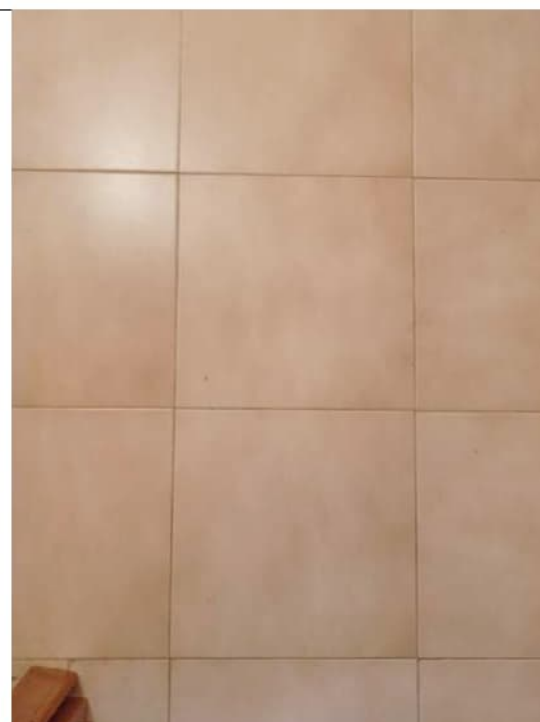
Particolare della tipologia di pavimentazione, in piastrelle di ceramica, presente nell'immobile, ai piani terra e primo
